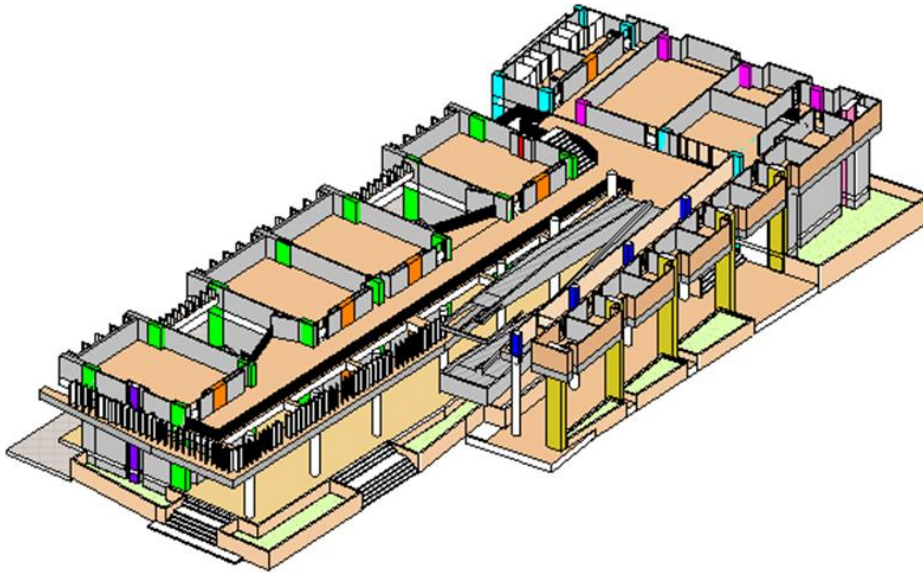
Vista Sección Arquitectónica planta N° 2.
